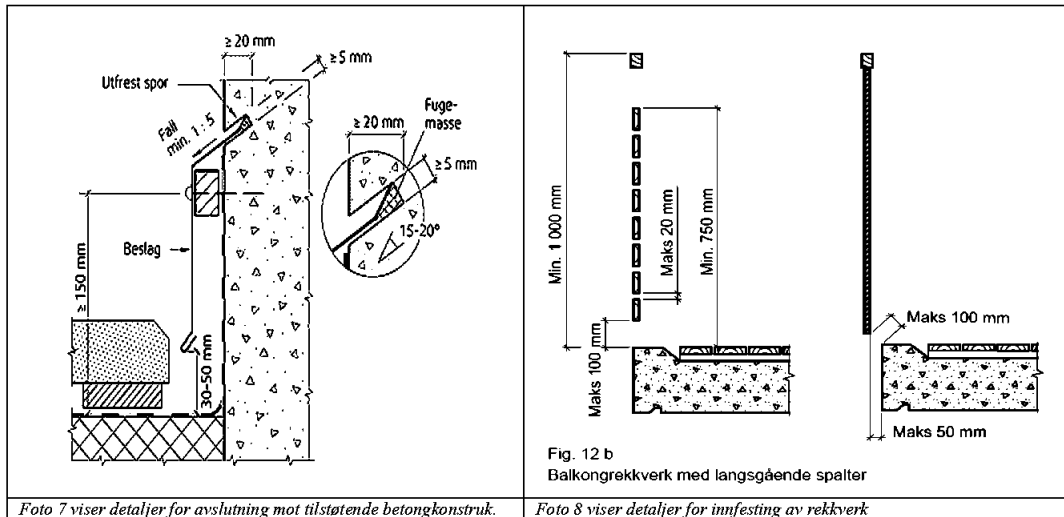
viser detaljer for avslutning mot tilstøtende betongkonstruk.
